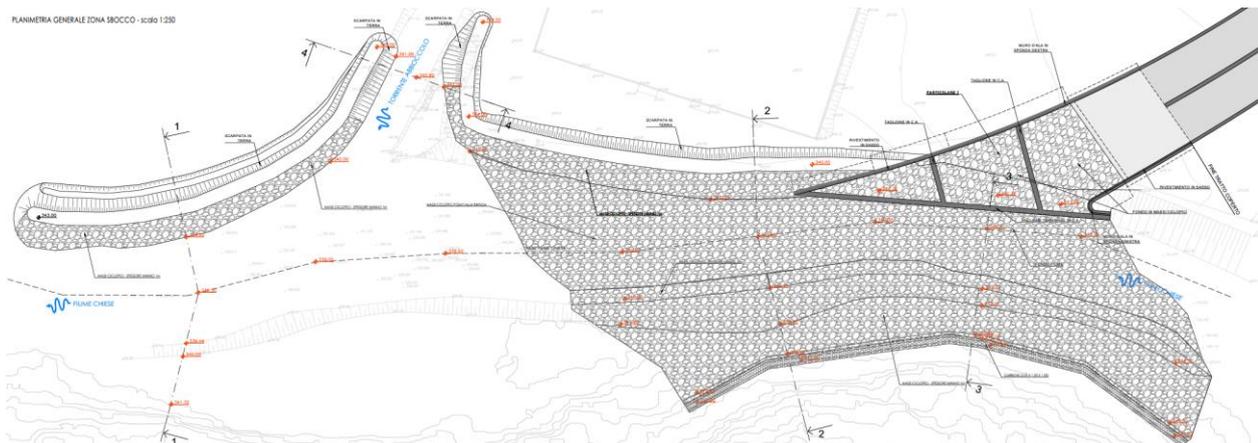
Planimetria opere di restituzione e di protezione confluenza galleria di by-pass / Chiese nel PE (elaborato: PE-ALV-ZSB-GE-001-PT-A)
